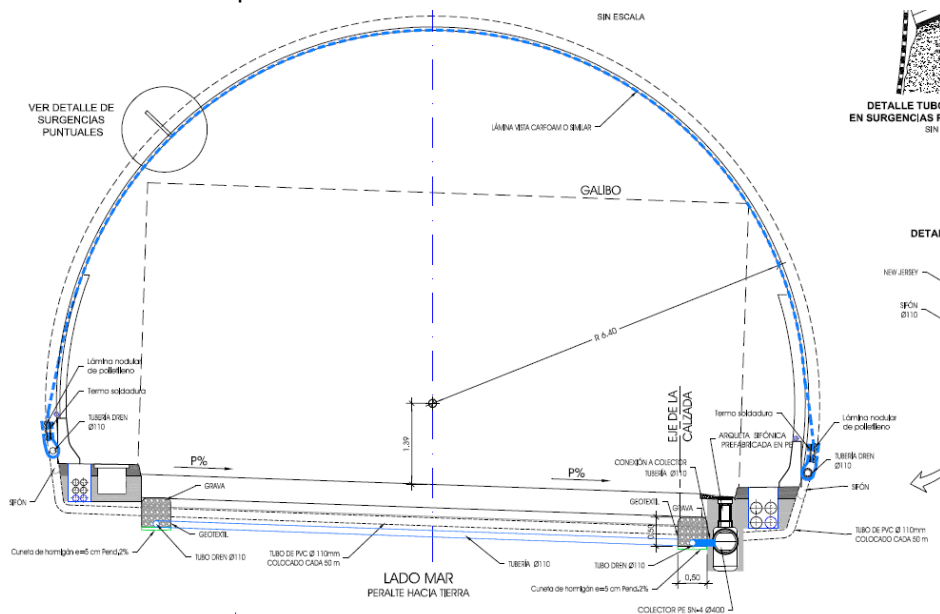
Sección Tipo Impermeabilización en Túnel
